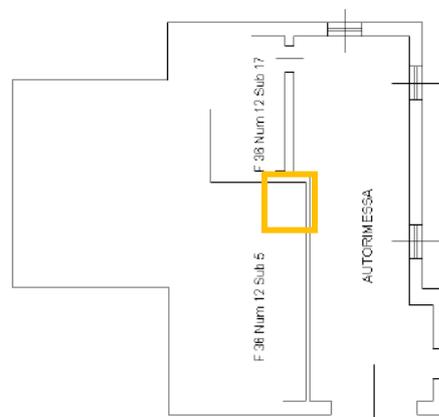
Planimetria Sub. 16 (attuale reperita dal CTU) con l'individuazione della porzione indebitamente incorporata
